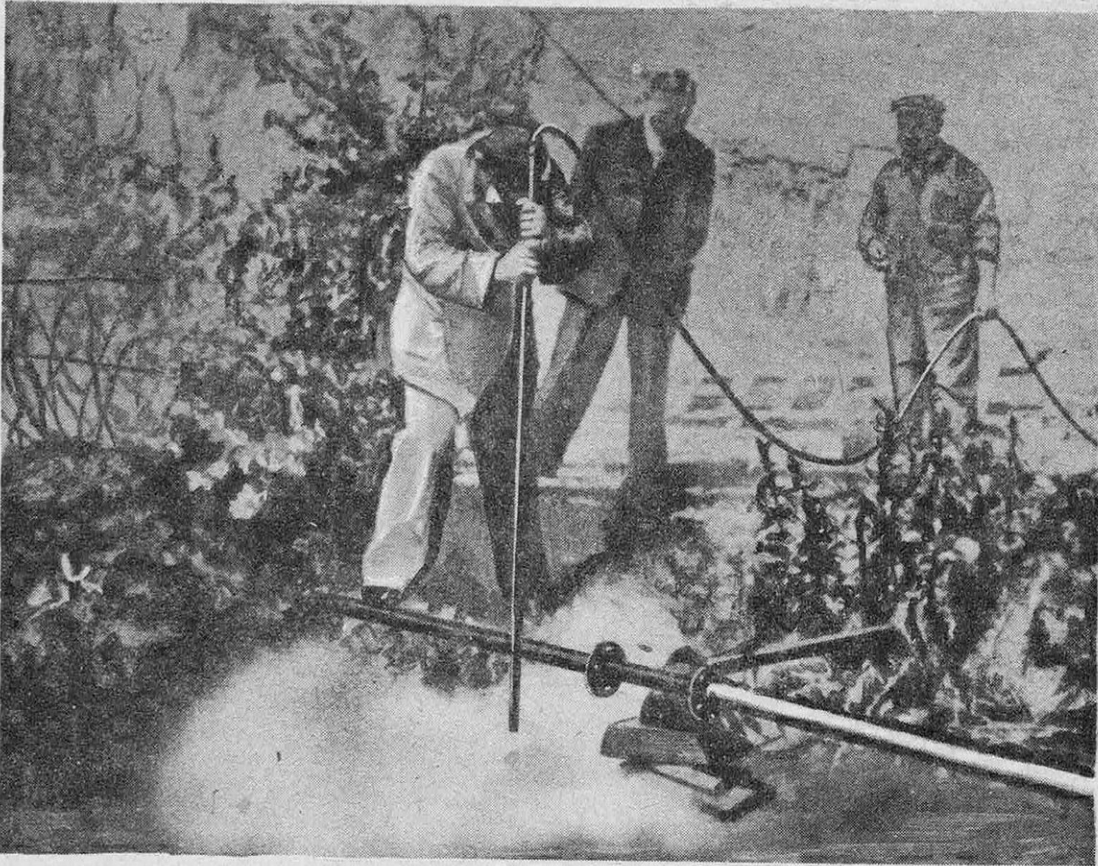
FORAGE VERTICAL SOUS L'EAU D'UN BLOC DE BÉTON (L'AIR LIQUIDE)
